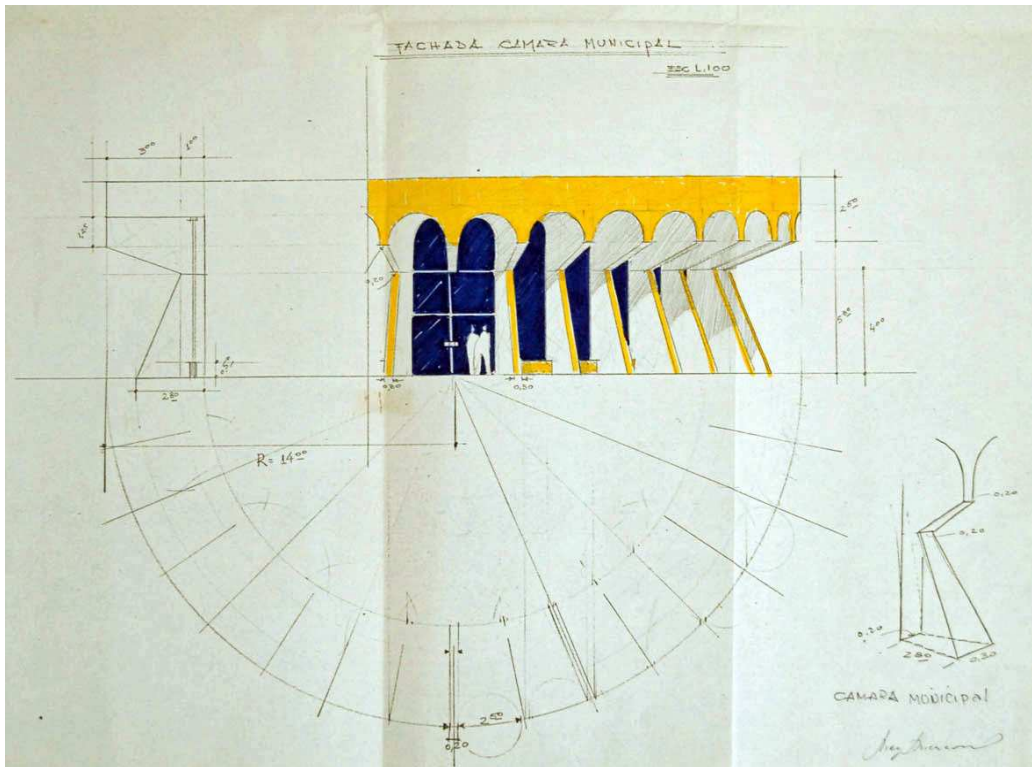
Ante – Projeto Centro Cívico Montes Claros – Fachada Câmara Municipal de Montes Claros
